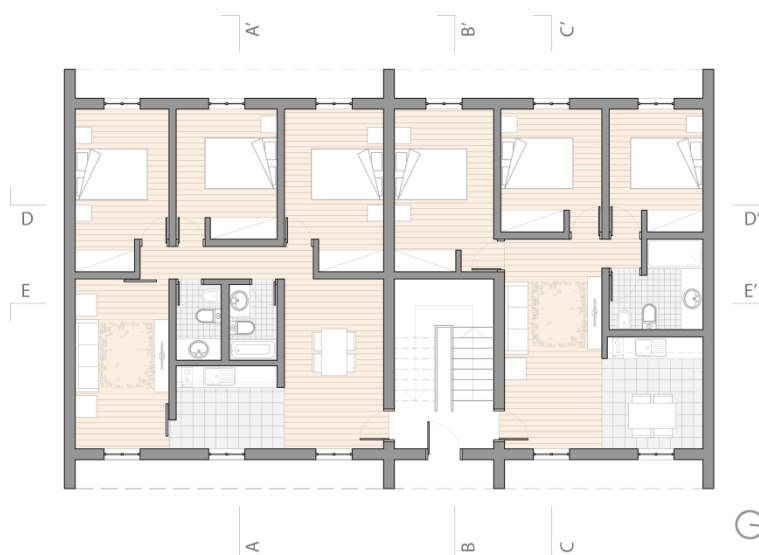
SOLUÇÃO A: Planta Piso Térreo
